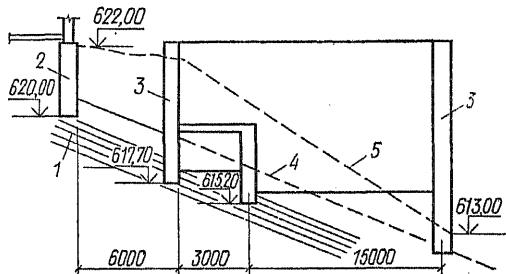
Строительство здания на склоне ниже существующего здания
